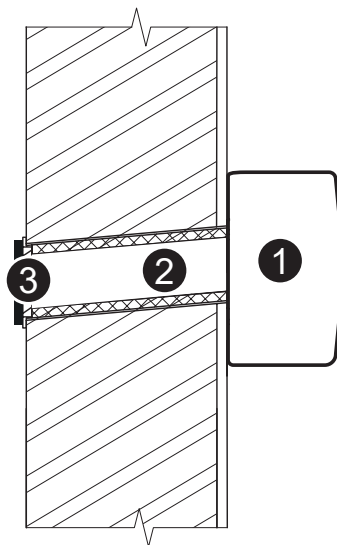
Крепление на стены из легких минеральных материалов (газобетон, шлакобетон, пенобетон)
